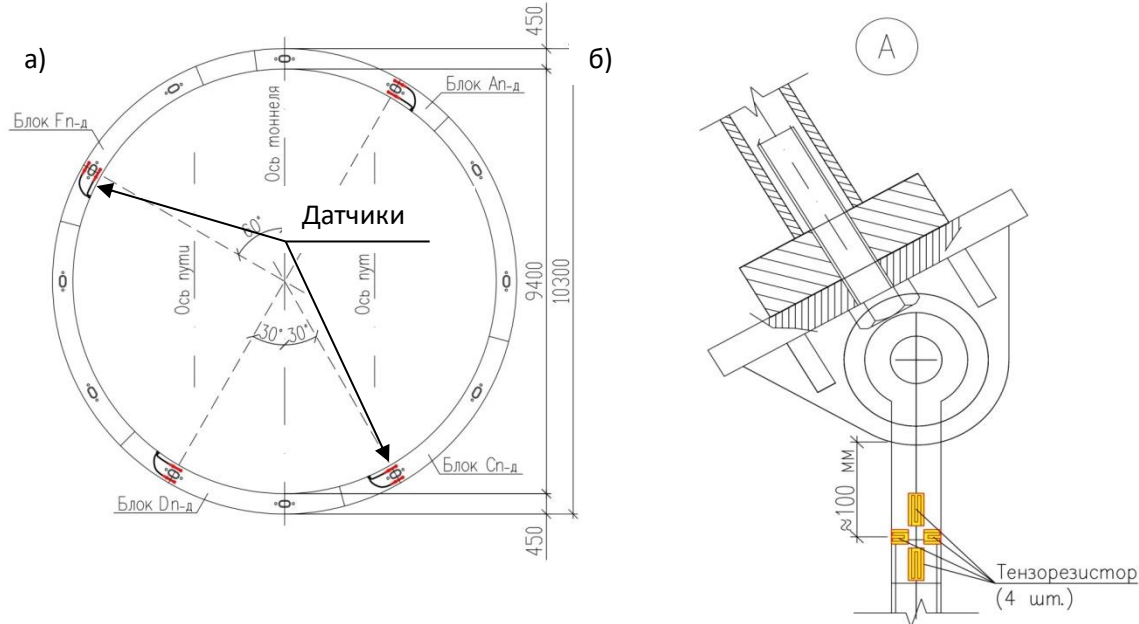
Схема размещения датчиков в обделке двухпутного перегонного тоннеля а) и на тросах подвесного перекрытия б).
